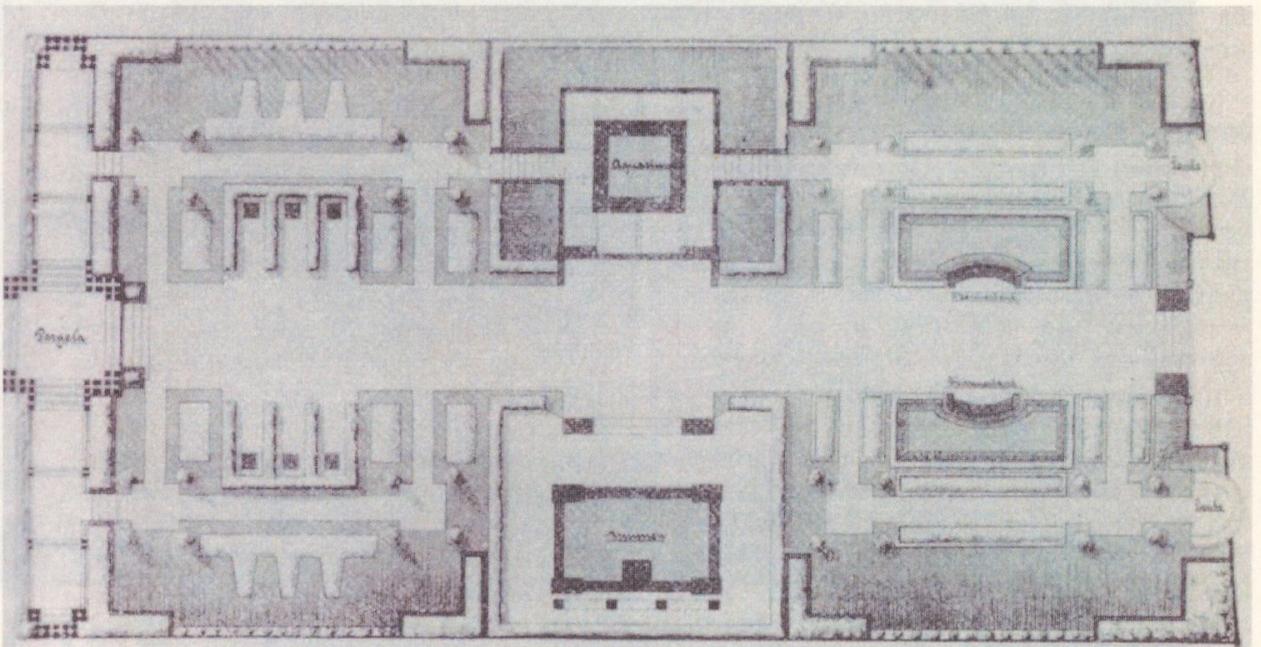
Grundriss der Gartenanlage auf der Großen Gartenbauausstellung Düsseldorf 1904
